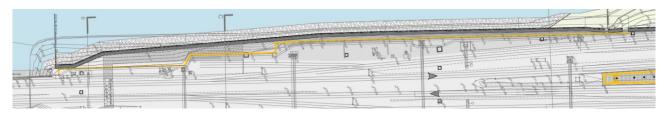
Planimetria Porgetto esecutivo su rilievo esistente
